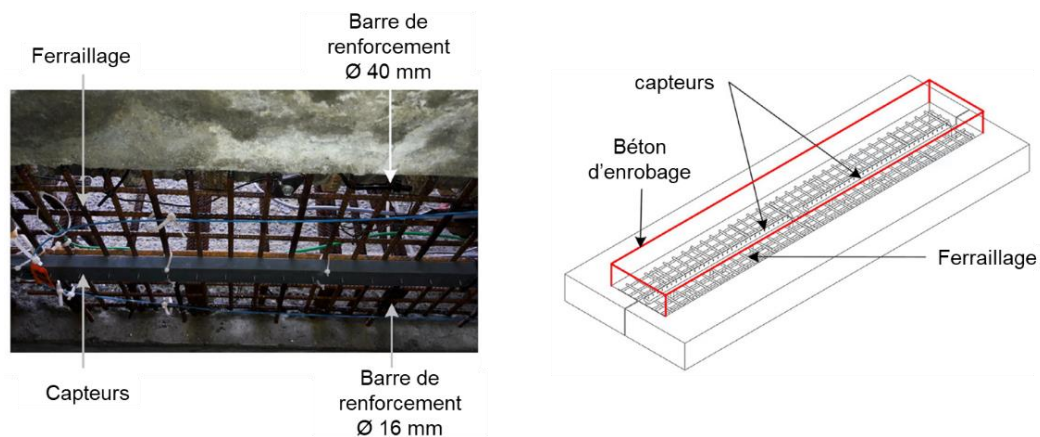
Capteur installé sur site avant coulage du béton et modèle numérique de l'ensemble ferrailage, capteur, béton d'enrobage (Priou et al. 2019)
